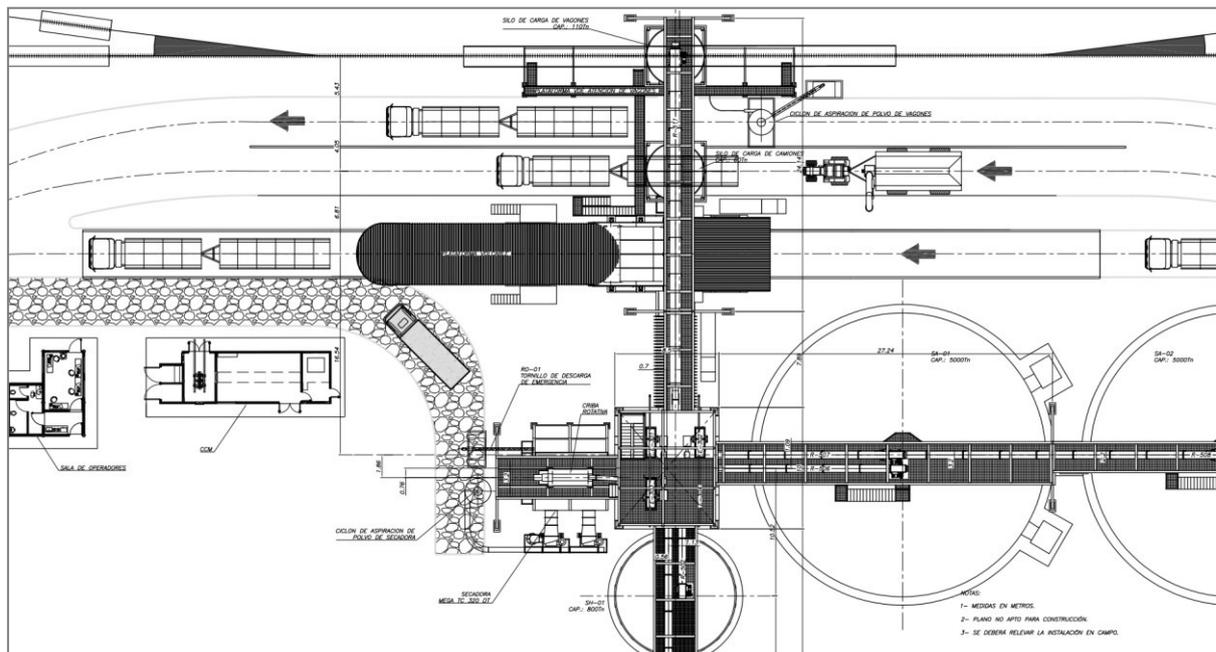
Elevador de la Planta. Fuente: Excel Consulting
